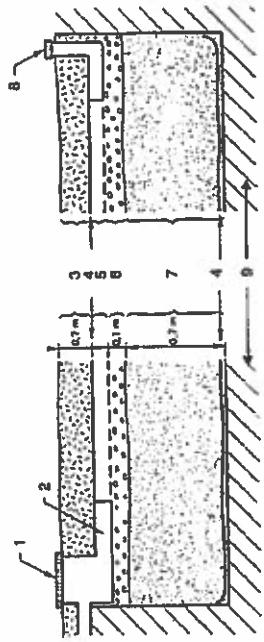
Filtre à sable vertical non drainé - Coupes transversales
